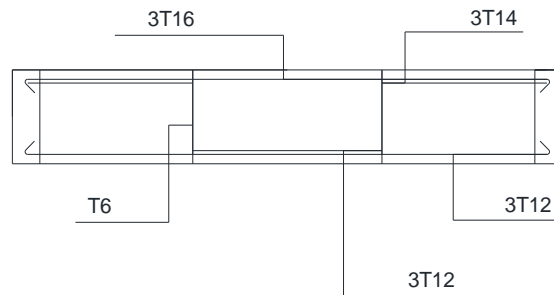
Coupe longitudinale d'une poutre normale principale 25x35cm (plan fortement irrégulier)
